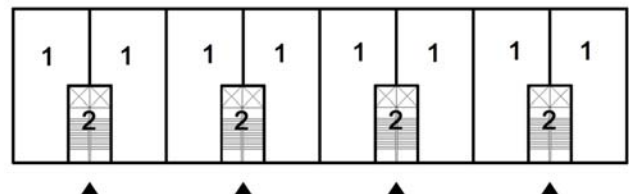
Схематический план многоэтажного-секционного дома (slab block): 1-жилые помещения, 2-лестнично-лифтовой узел.
